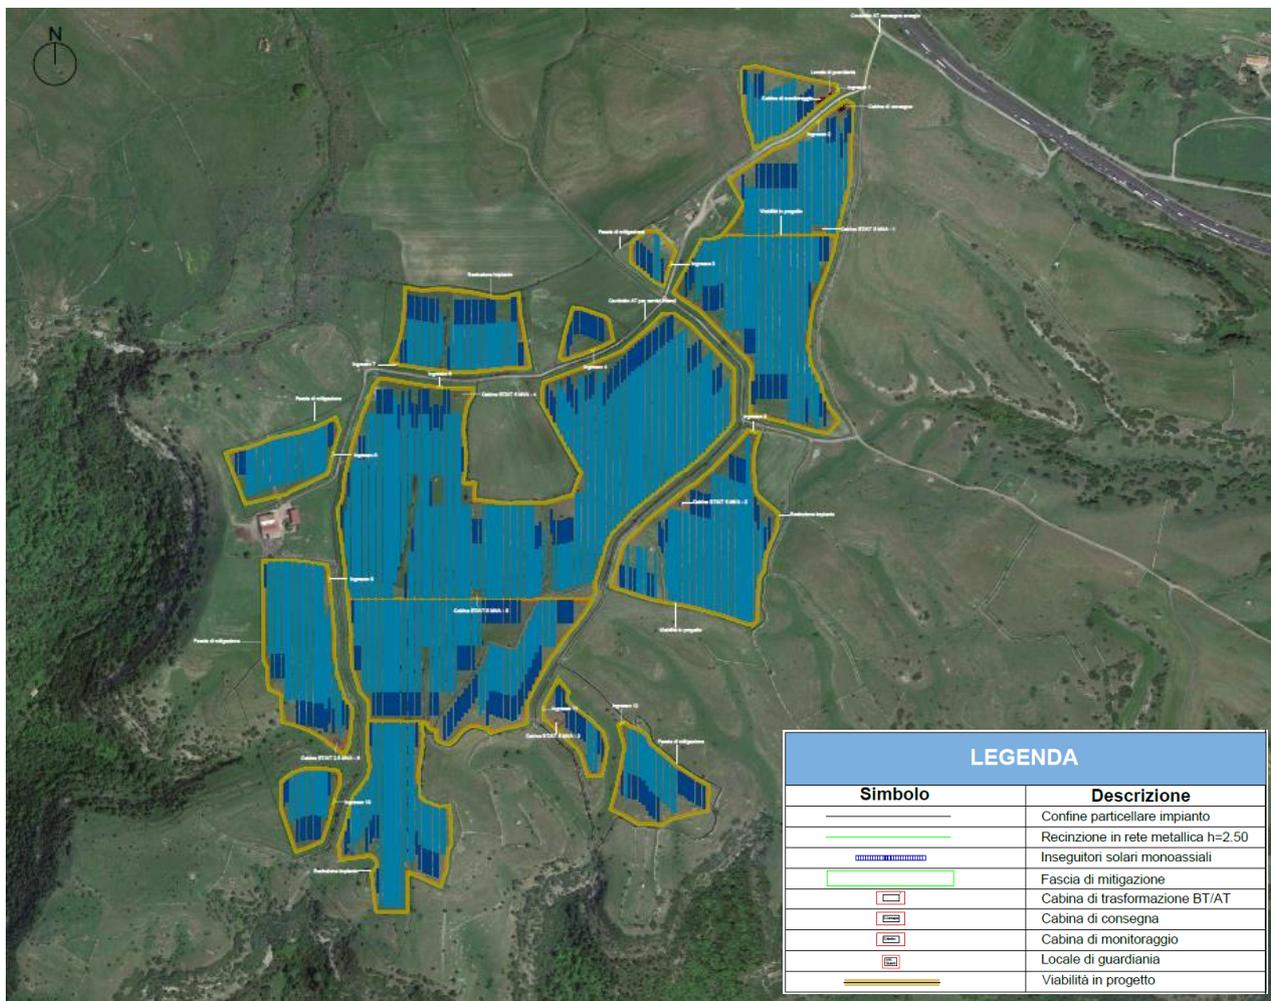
LAYOUT PLANIMETRICO DELL'AREA D'IMPIANTO
